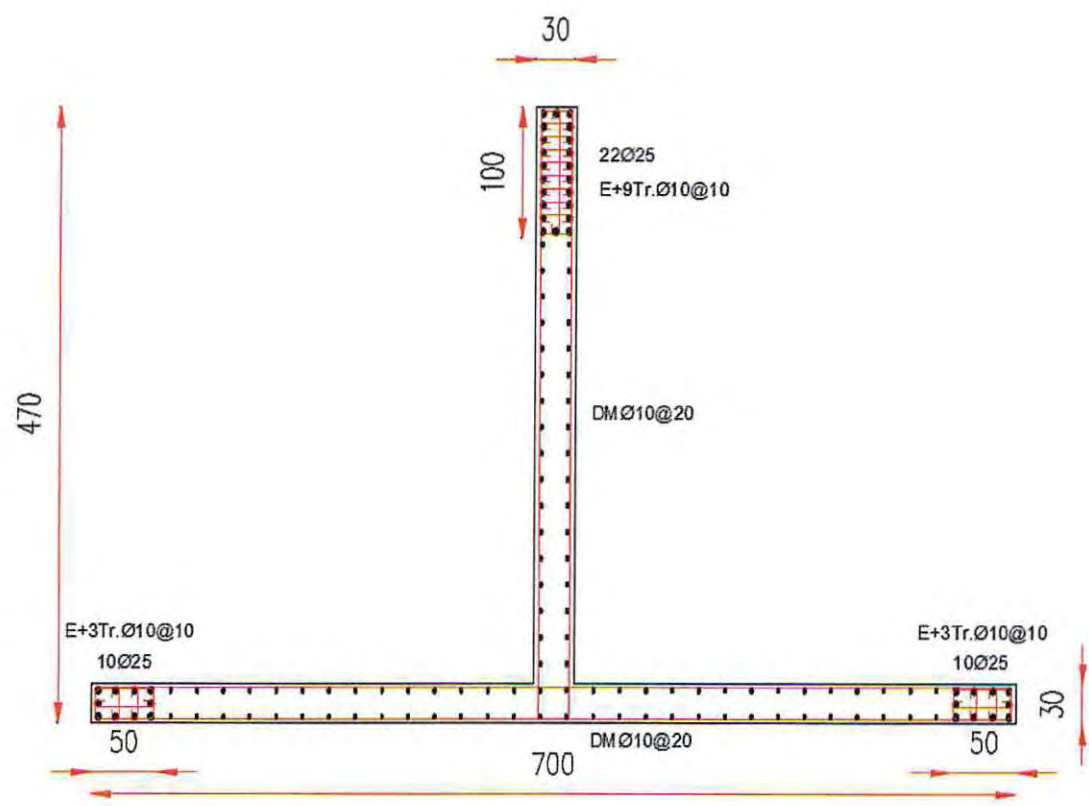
Disposición armadura Ed. Tradicional muro "T".
